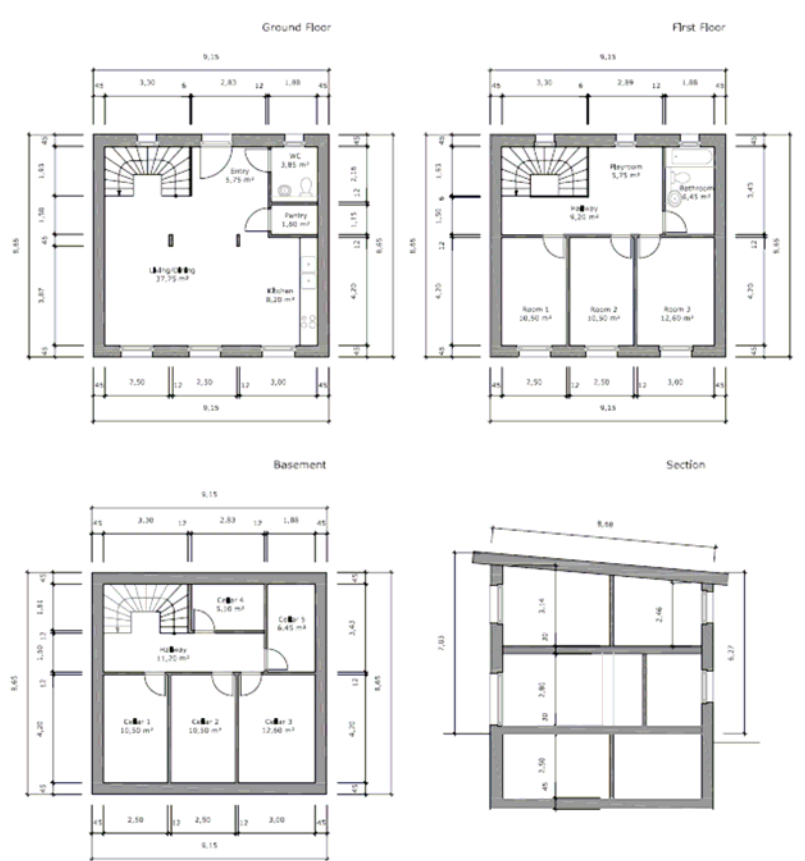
IBO-Modell-Einfamilienhaus - Grundrisse und Schnitt
